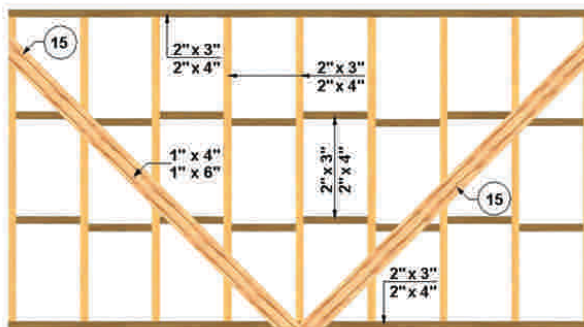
21: Muro arriostrado con tabla de madera encastrada, pieza N° 15.
